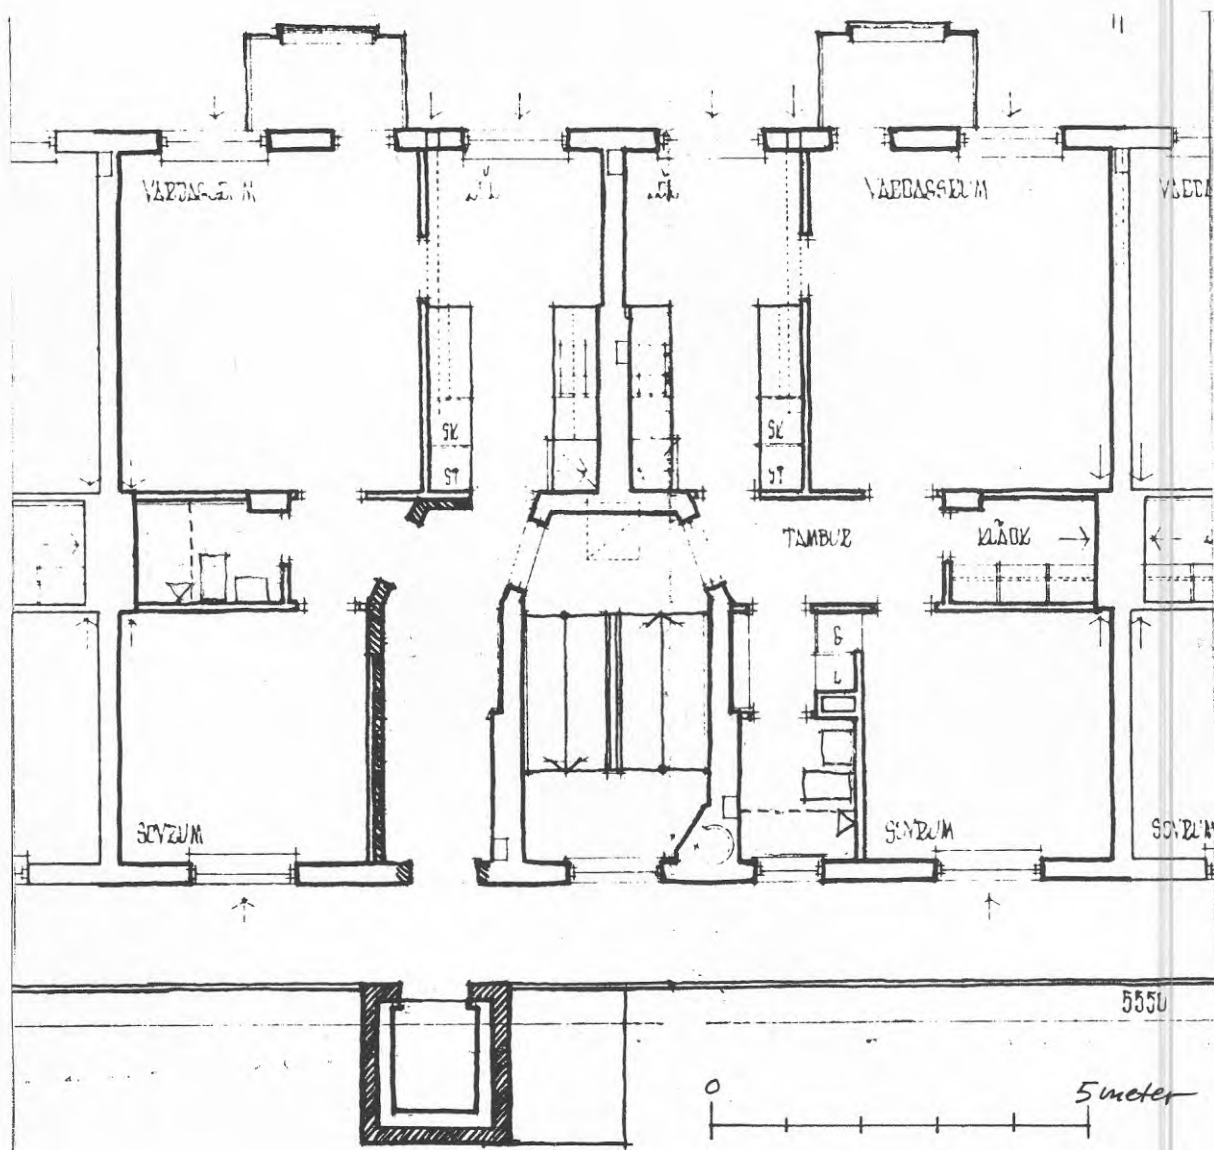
Kv. Skyfallet 1 (Plan skala 1:100)
